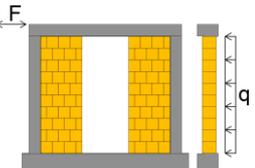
Details des entwickelten Systems zur Entkopplung von Mauerwerksausfachungen von Stahlbetonrahmen
